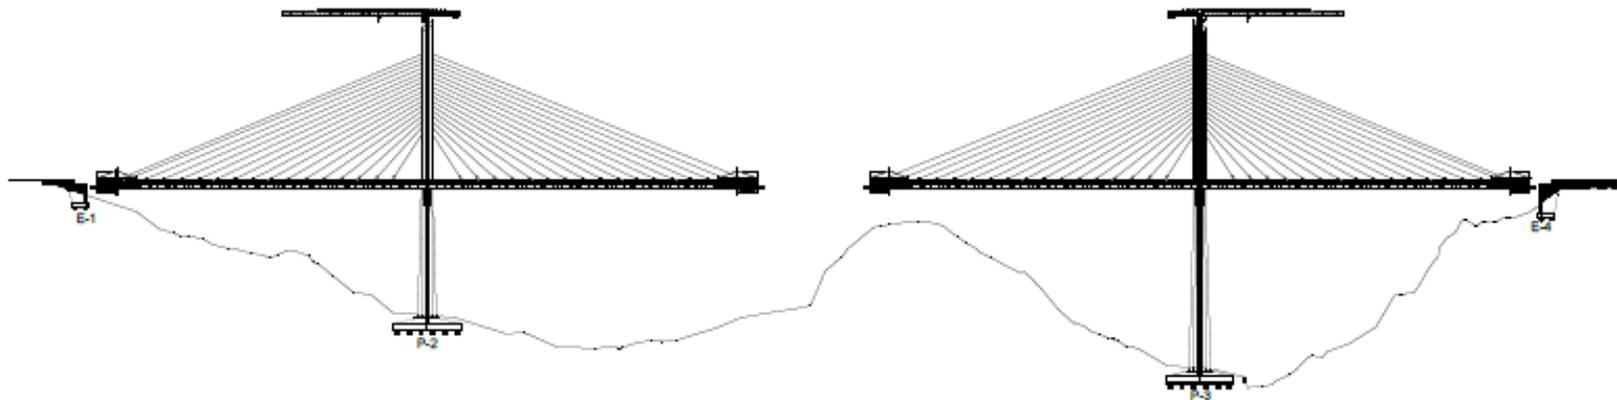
Fase 9: Construcción de Dovela-18 sobre obra falsa en estribos, Construcción de Dovela-18 en Claro-2, Colocación de Tirante 18
